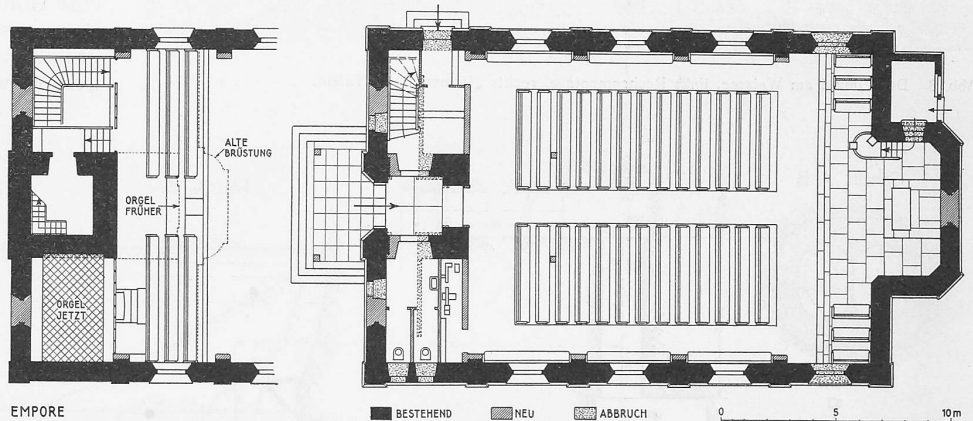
Grundrisse zum Umbau der Kirche in Obfelden. — Masstab 1 : 300.
